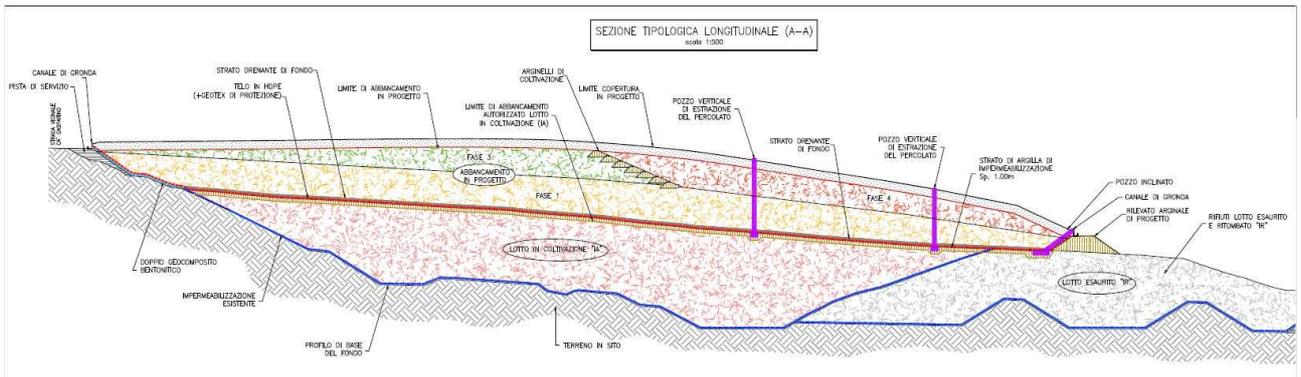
sezione longitudinale tipologica del progetto autorizzato
